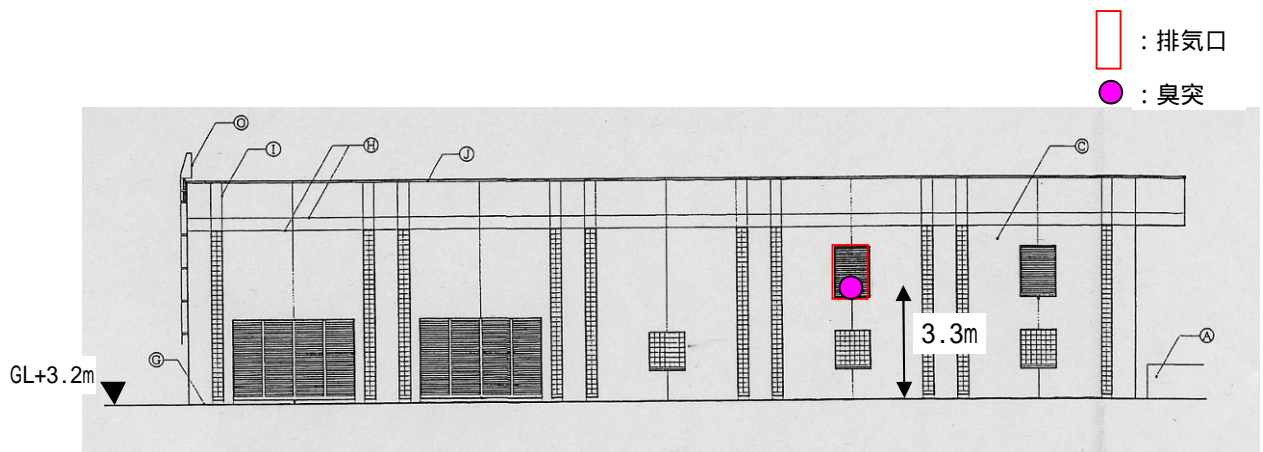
水処理施設 No1,2 排気チャンバー（南 立面図）
